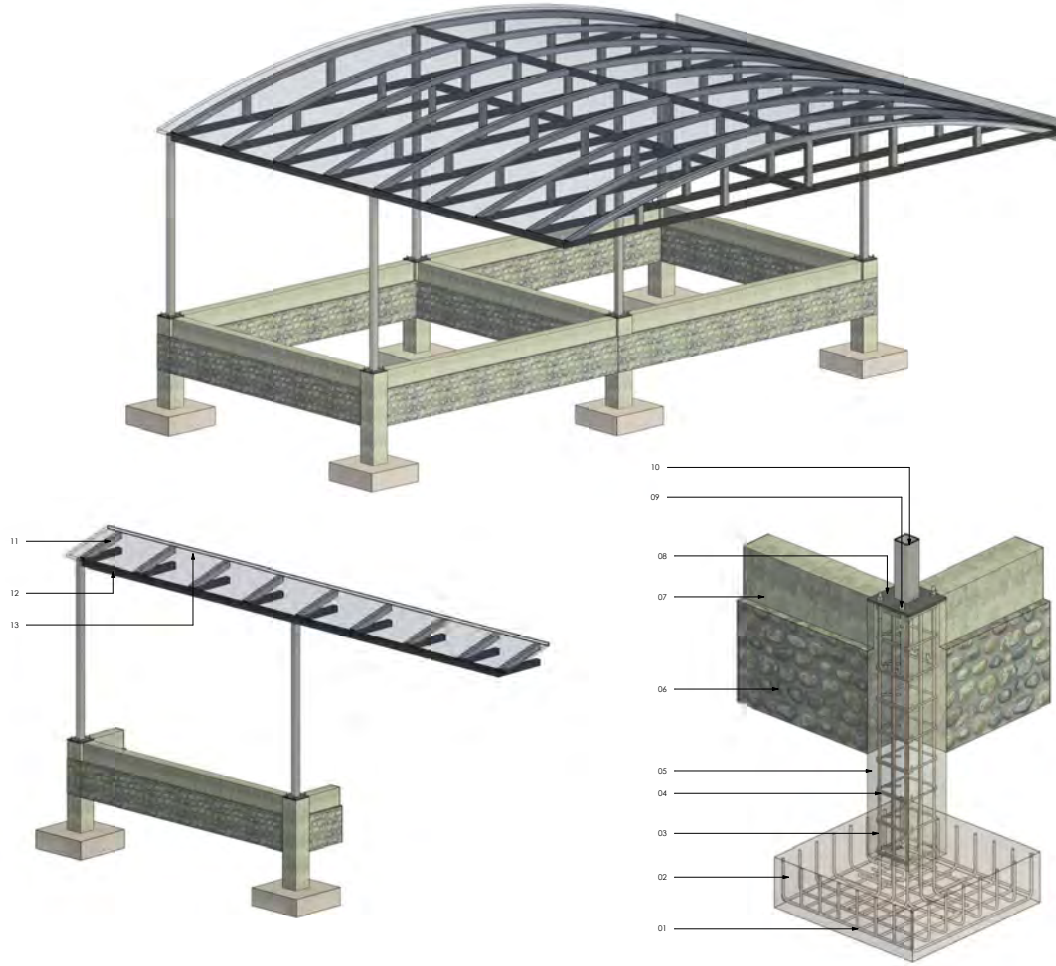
Detalle constructivo 02. Fuente: Elaboración propia
